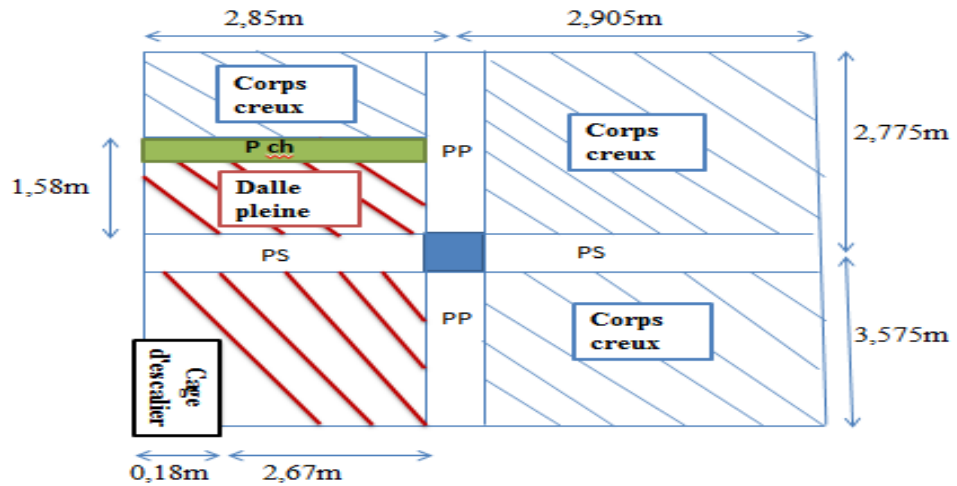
la surface supporte par le poteau central (de 1^{er} jusqu'à 10^{eme} étage).
